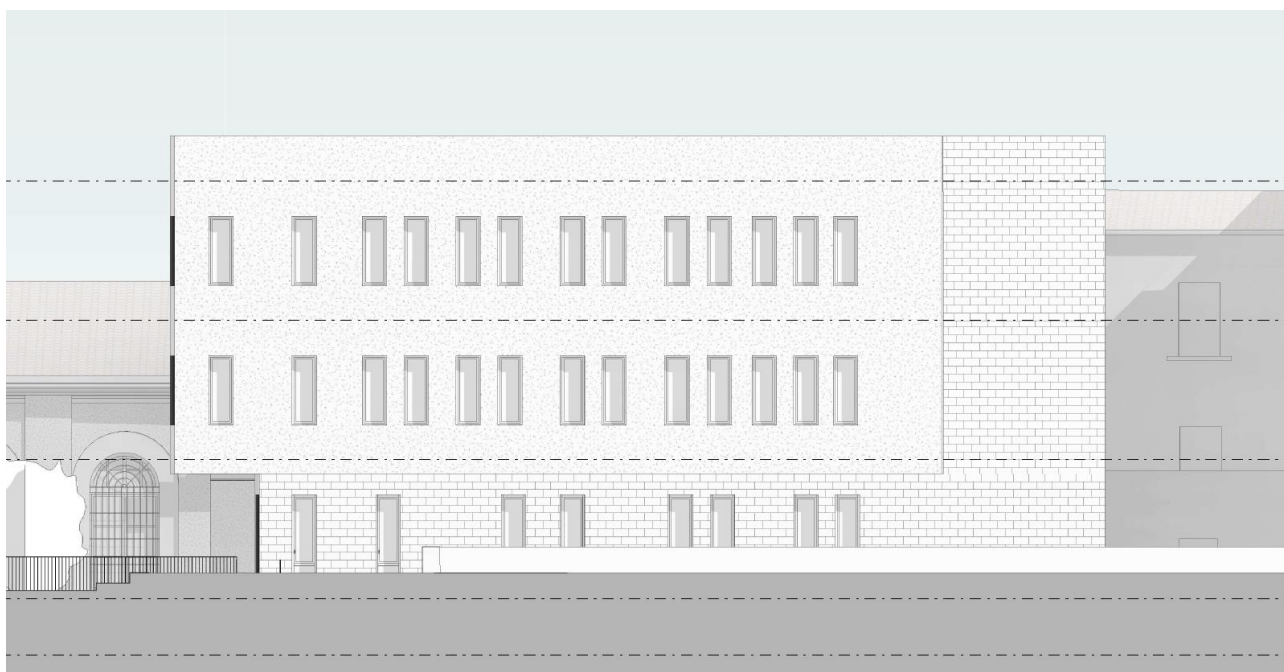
prospetto lato ferrovia (prospetto sud-ovest)
